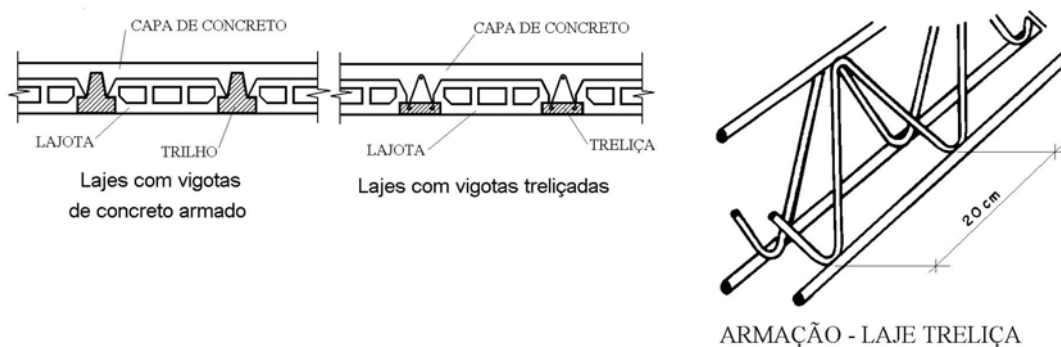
Seções transversais de lajes pré-fabricadas com vigotas de concreto armado, com vigotas treliçadas e perspectiva esquemática da armadura em treliça.
